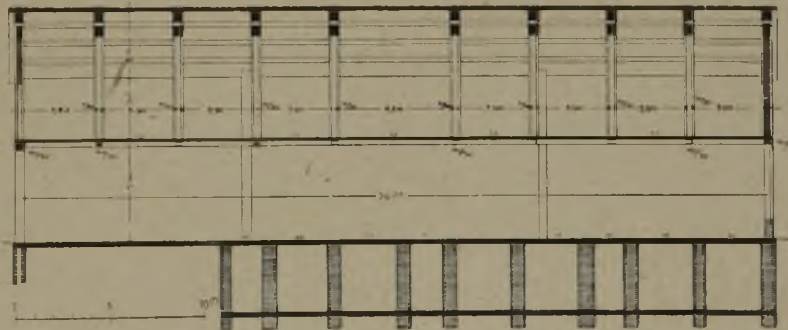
(oben). Dachkonstruktion mit aufgestellter Schalung.
